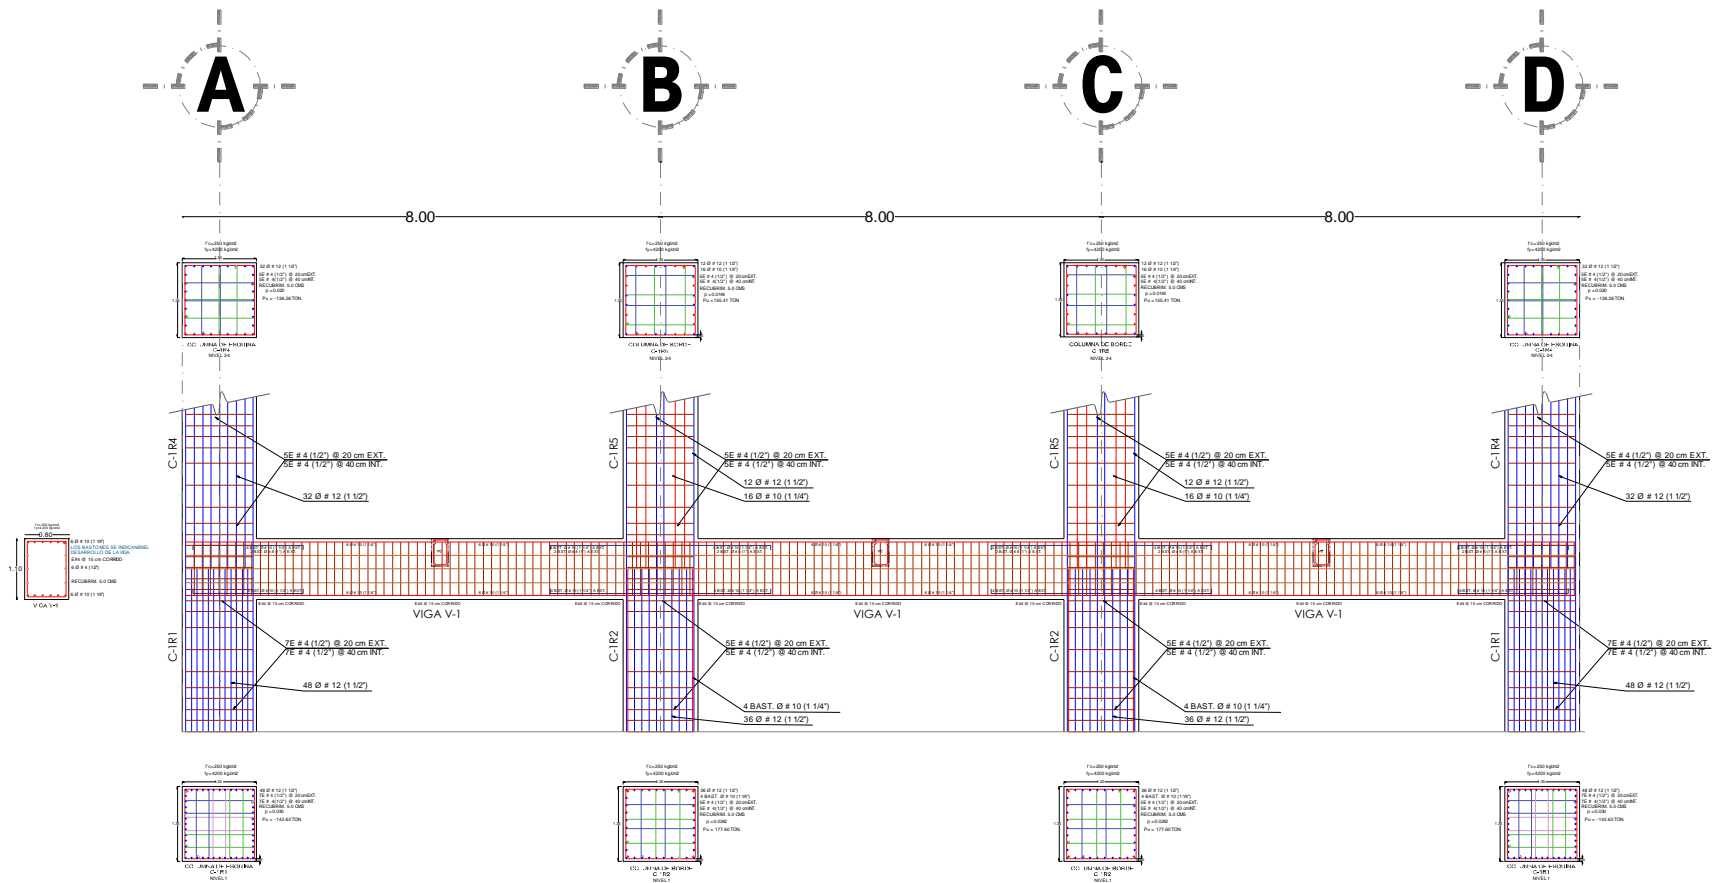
Alzado de armado de columnas y vigas de edificio de 12 niveles con base a la hipótesis de las NTCC-04.
